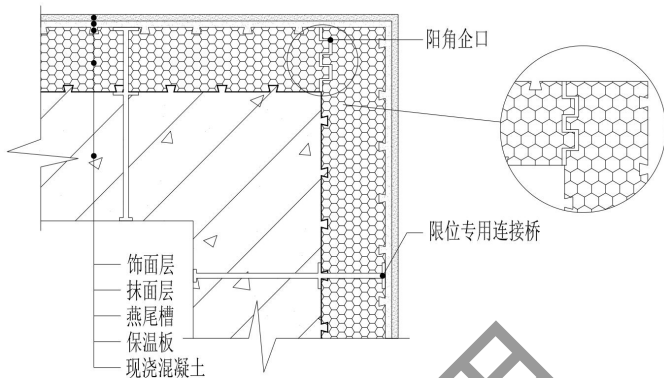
现浇混凝土大模内置保温系统阳角部位示意图
